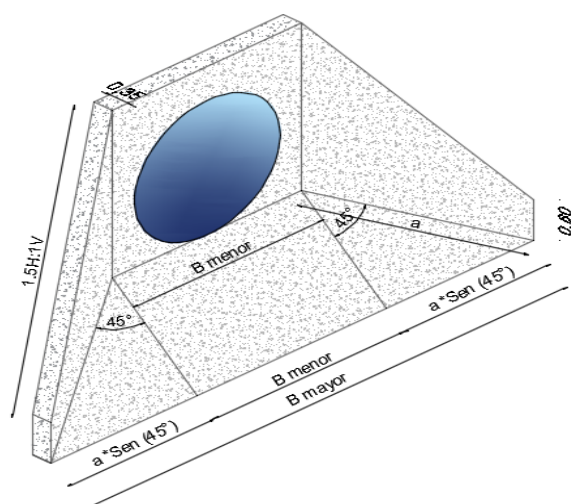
Sección tipo del muro de alero y losa de fondo para protección de entrada y salida de alcantarillado
